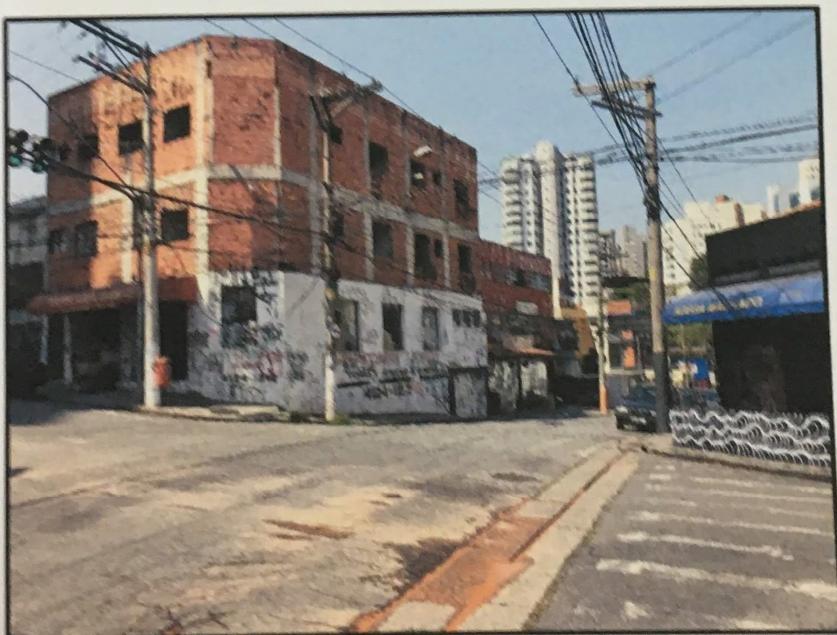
Rua Paulo Afonso x Travessa Paulo Afonso – Vista Geral do Imóvel
